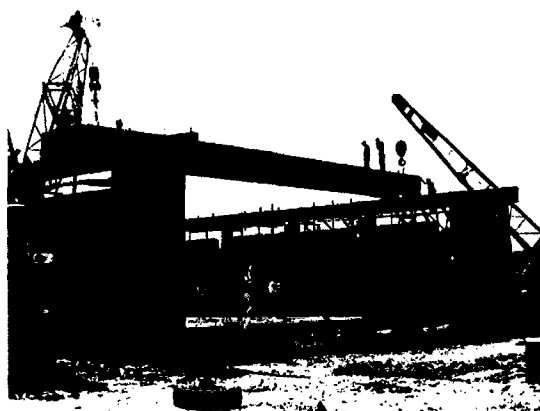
Manufacturas La Libertad – Montaje de las vigas prefabricadas de concreto postensado.
